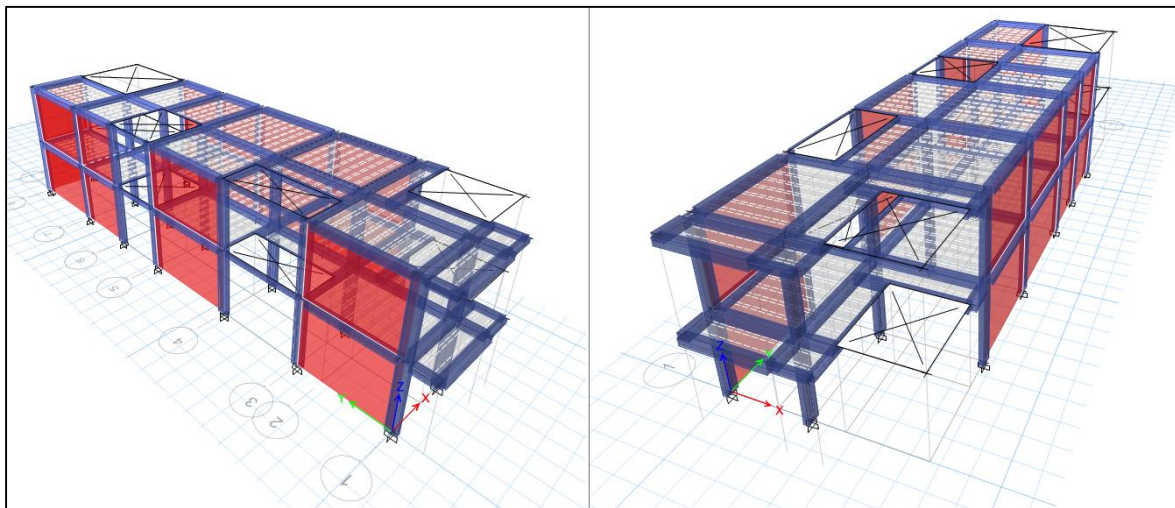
Modelo estructural de la situación actual de la vivienda 1 – Vista en perspectiva del primer y segundo nivel. Fuente: propia
